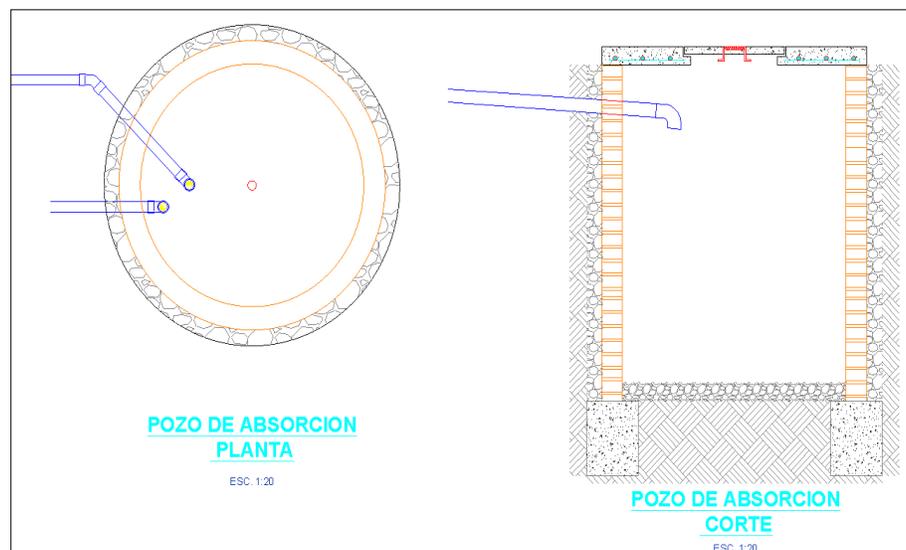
Vista en planta y corte de pozo de absorción con paredes de mampostería.
